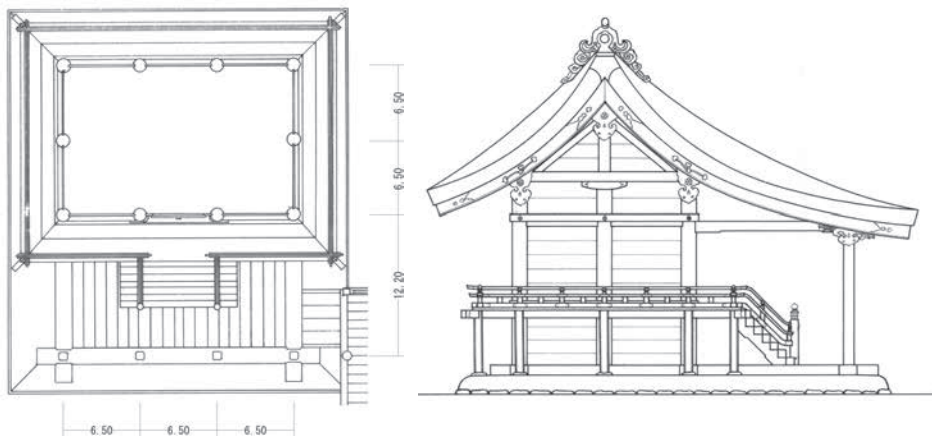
下鴨社西本殿 平面図(左)及び側面立面図(単位：尺、京都府所蔵図面)
